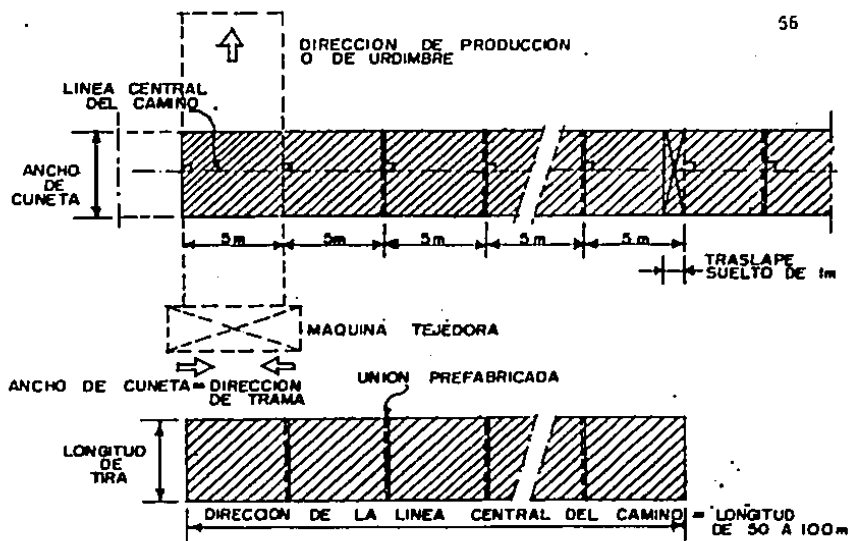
CONSTRUCCION DE CAMINOS CON GEOTEXTILES
